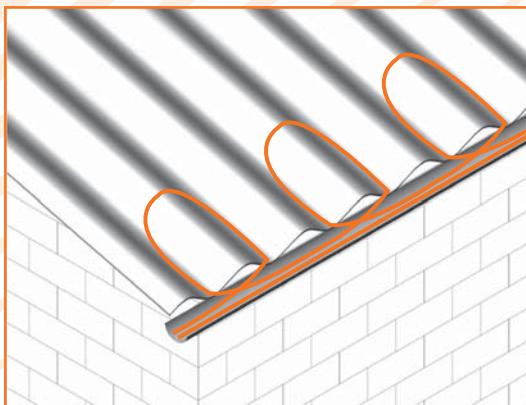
Укладка саморегулирующегося кабеля на металлической кровле
